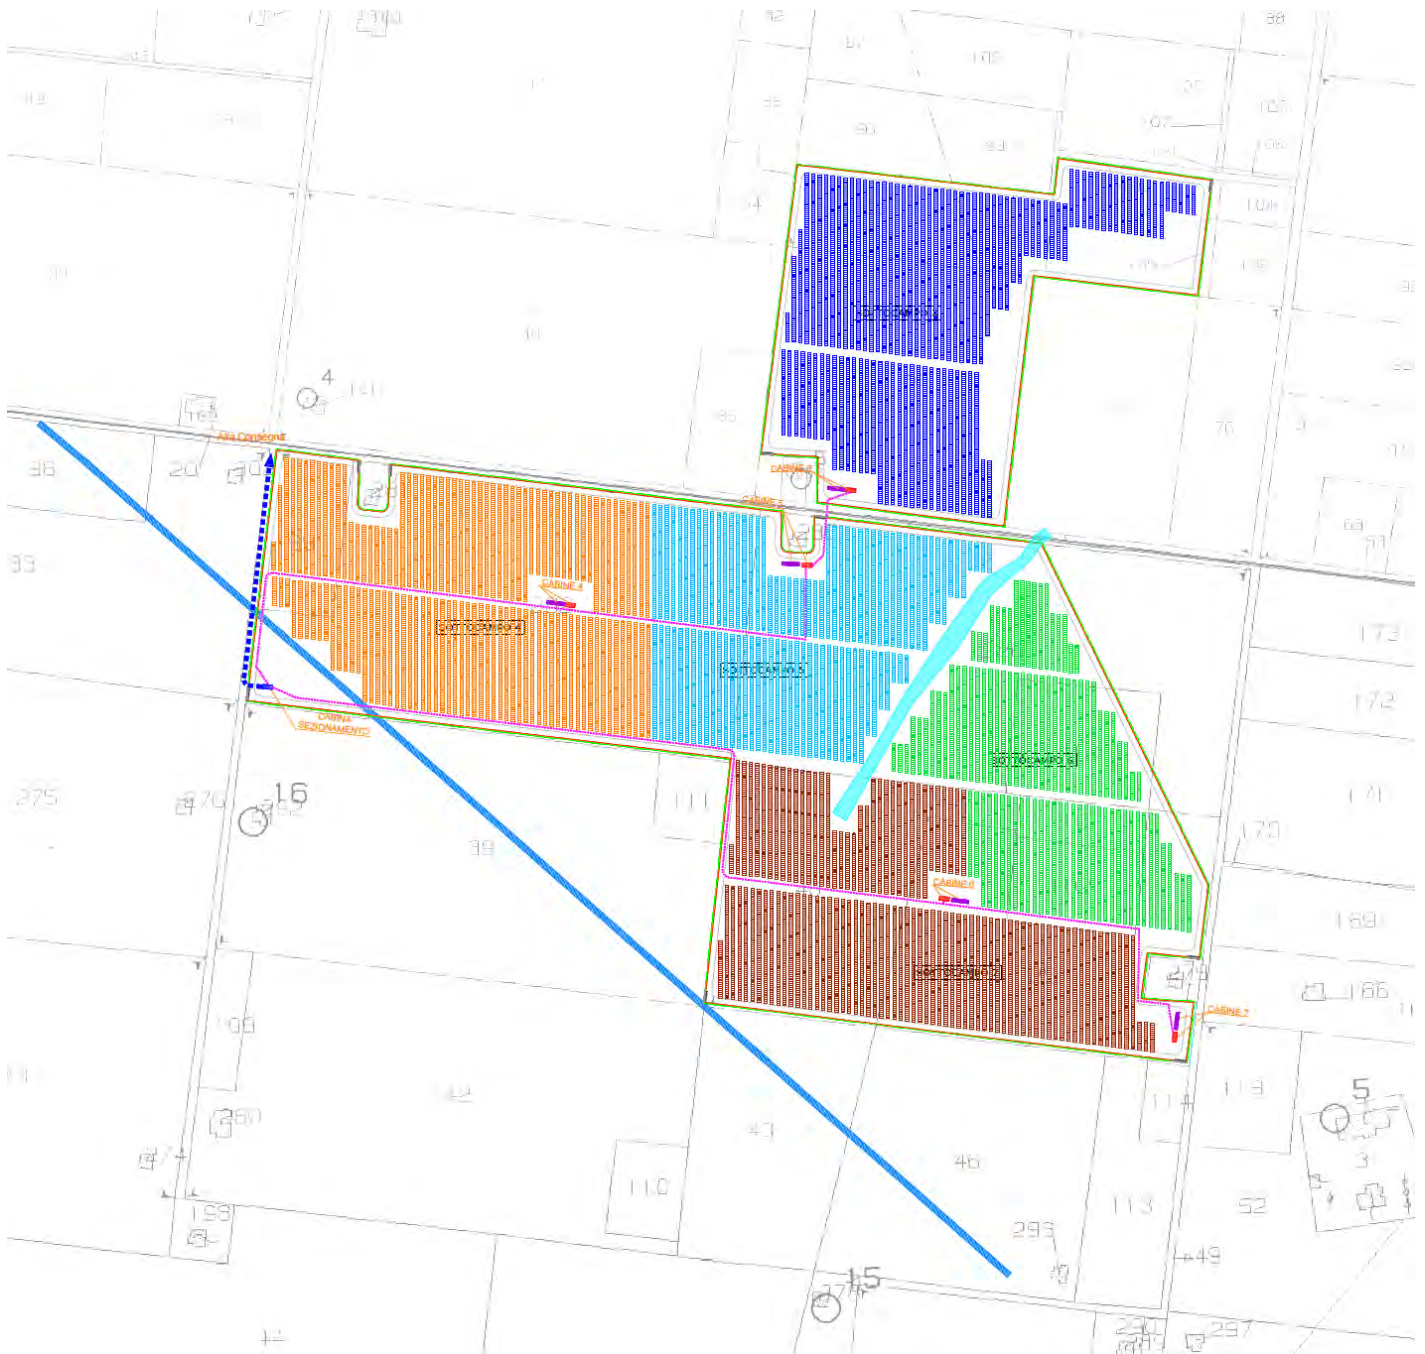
Planimetria con individuazione degli inverter ai fini del calcolo
